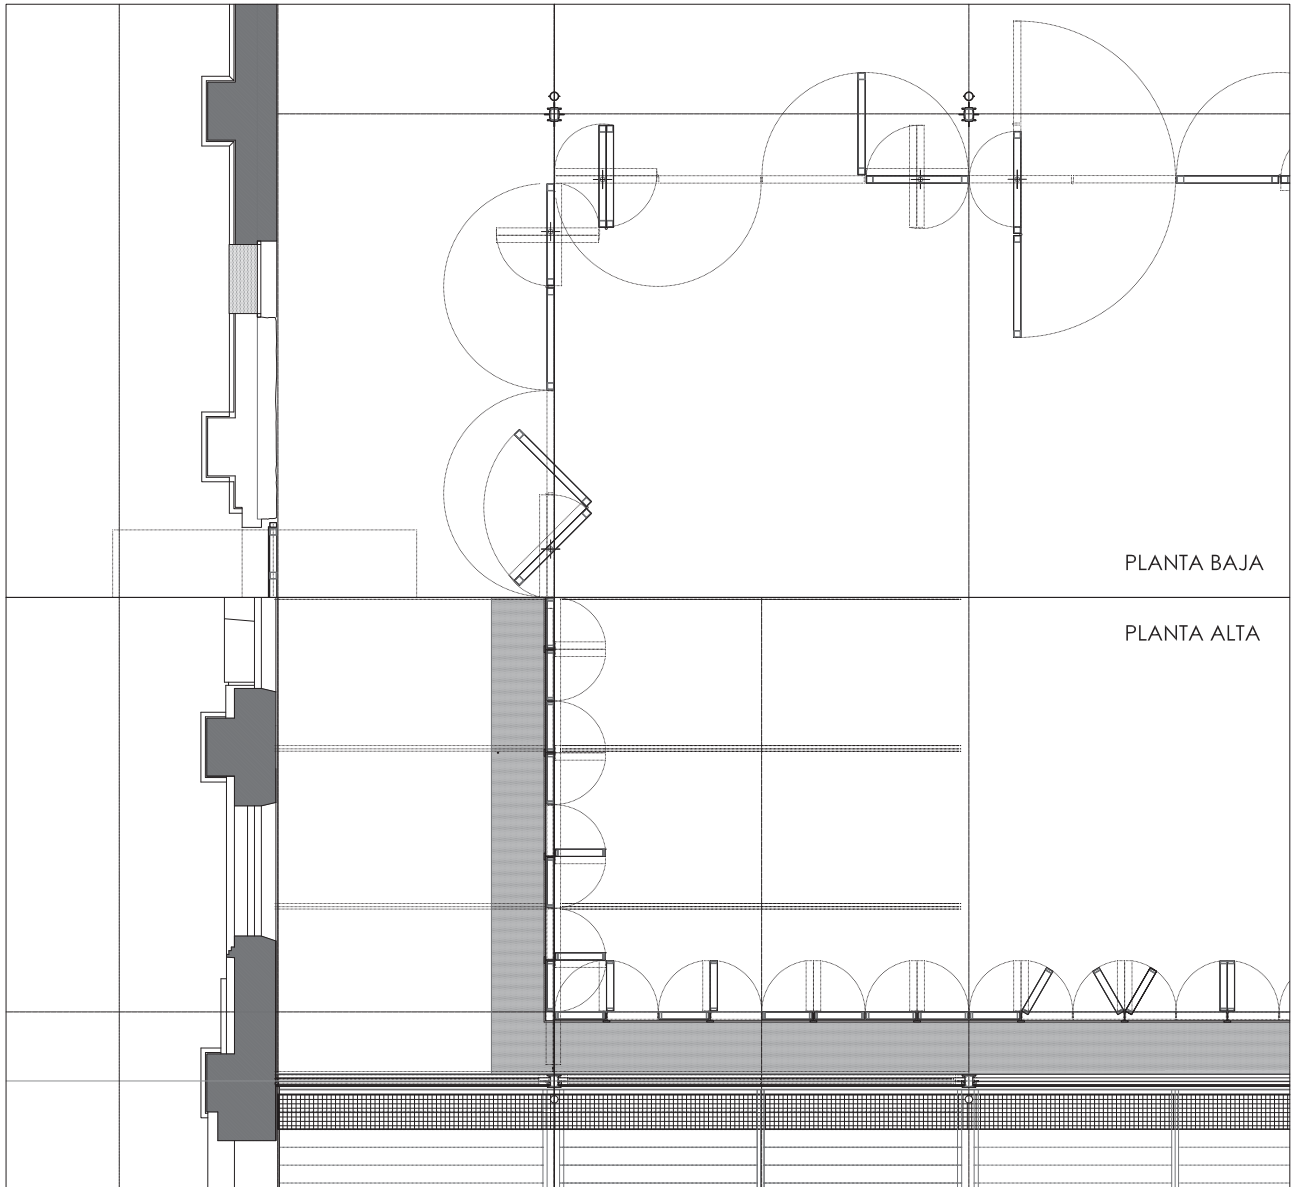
\_Detalles en planta alta y baja de apertura sistema de cerramiento y detalle y fotografías de los accesos. Imágenes cedidas por los autores Carnicero+Vila+Virsedá
